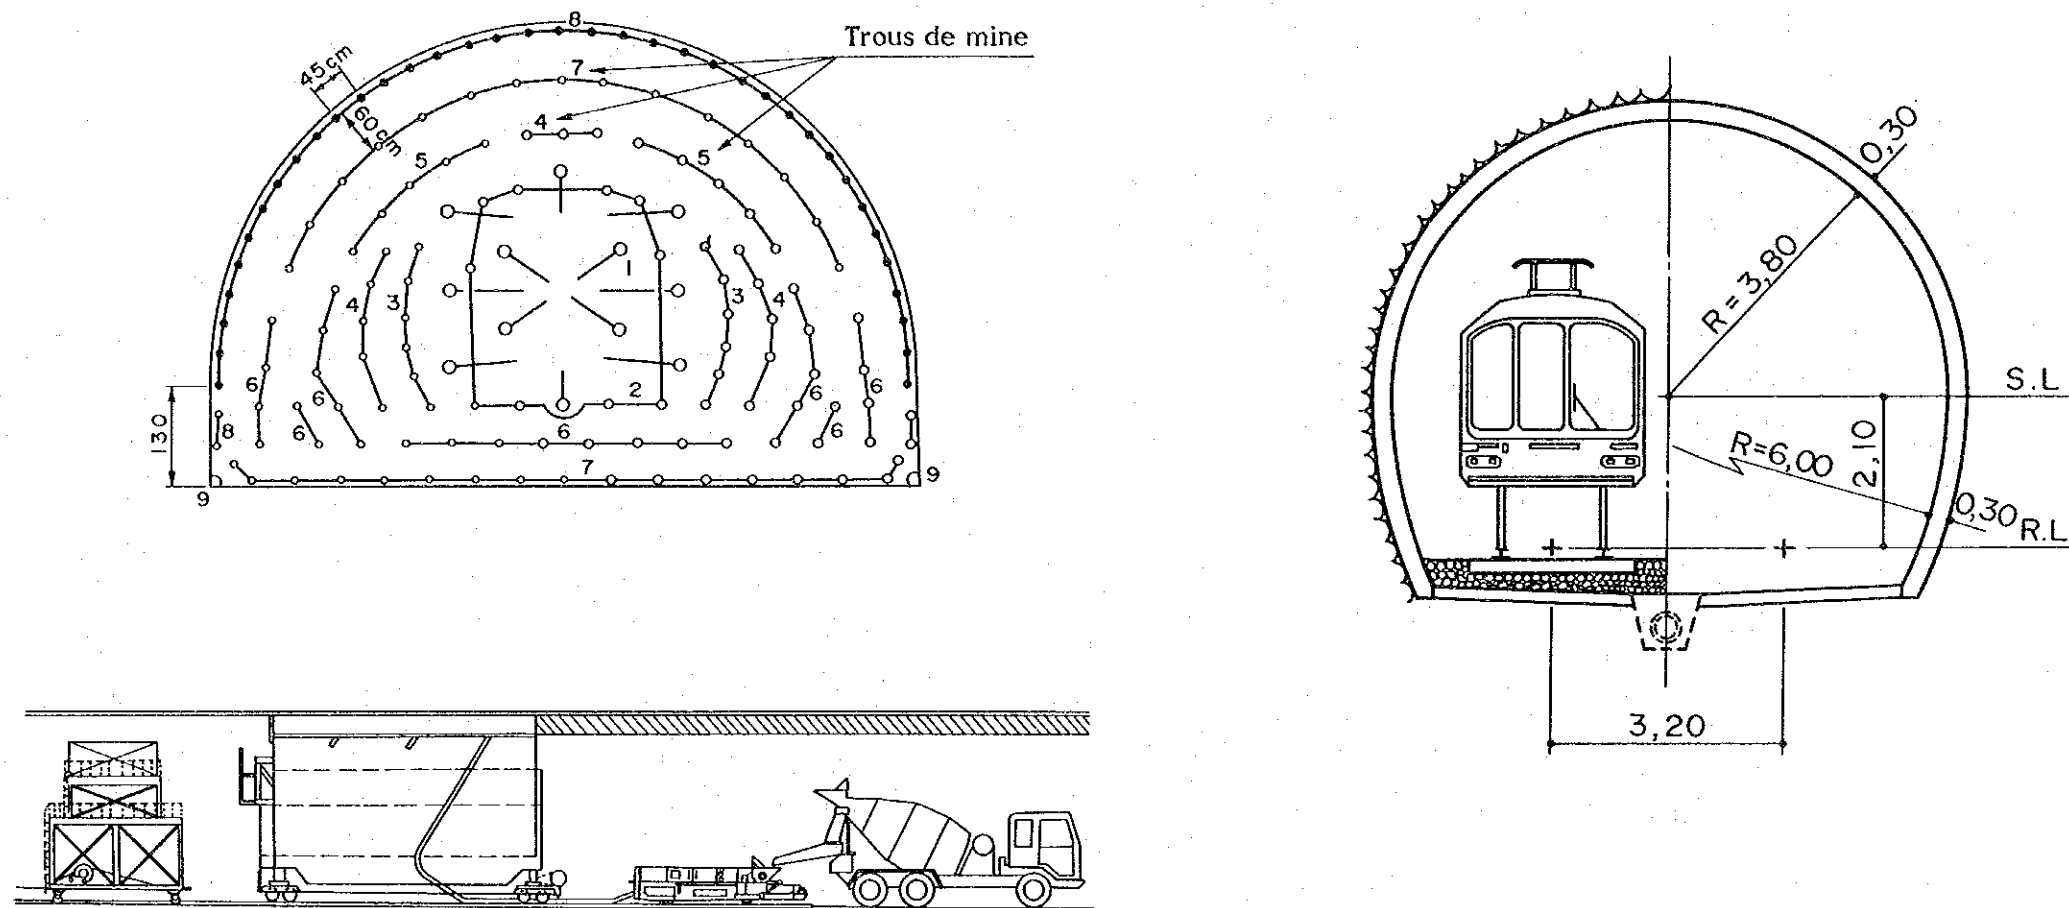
Emplacement des trous de mine et plan de battage du béton de revêtement ainsi que le plan général du tunnel
